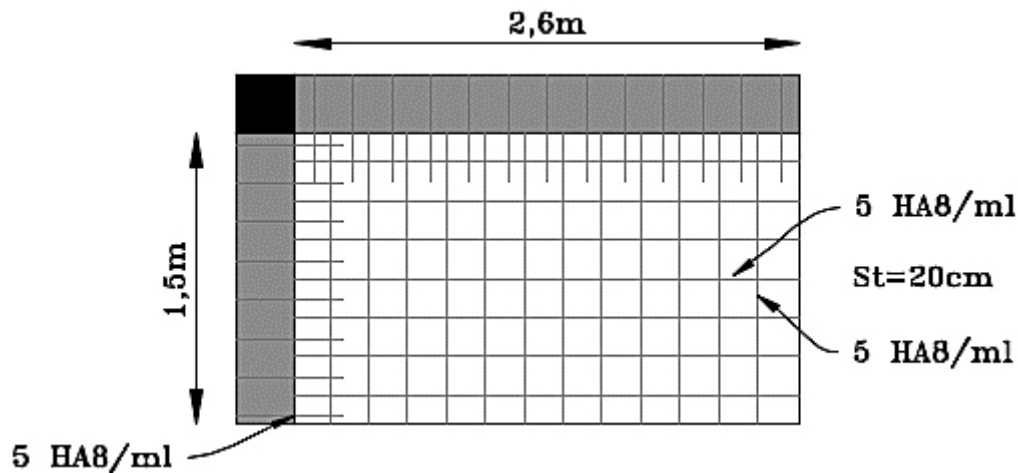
Schéma de ferrailage de la dalle sur 2 appuis.
